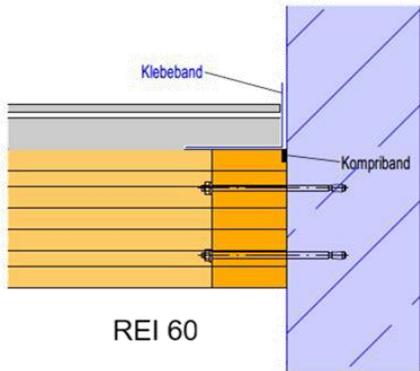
Anschluss BSP-Decke an Betonwand [B. Walter Ingenieurgesell. mbH]
